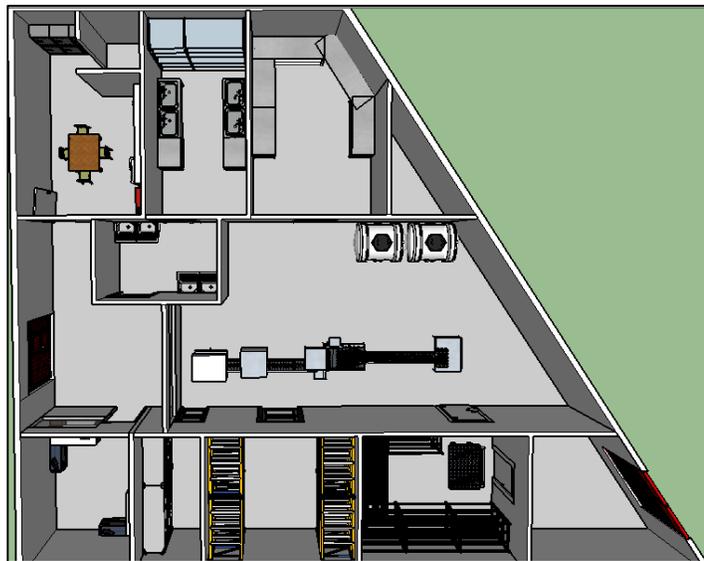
Diagrama de recorrido en el plano de la nueva planta
